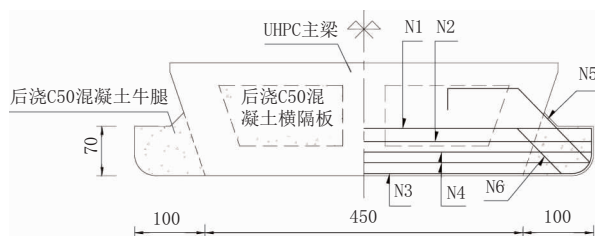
牛腿处构造及钢筋设置示意图(单位:cm)
